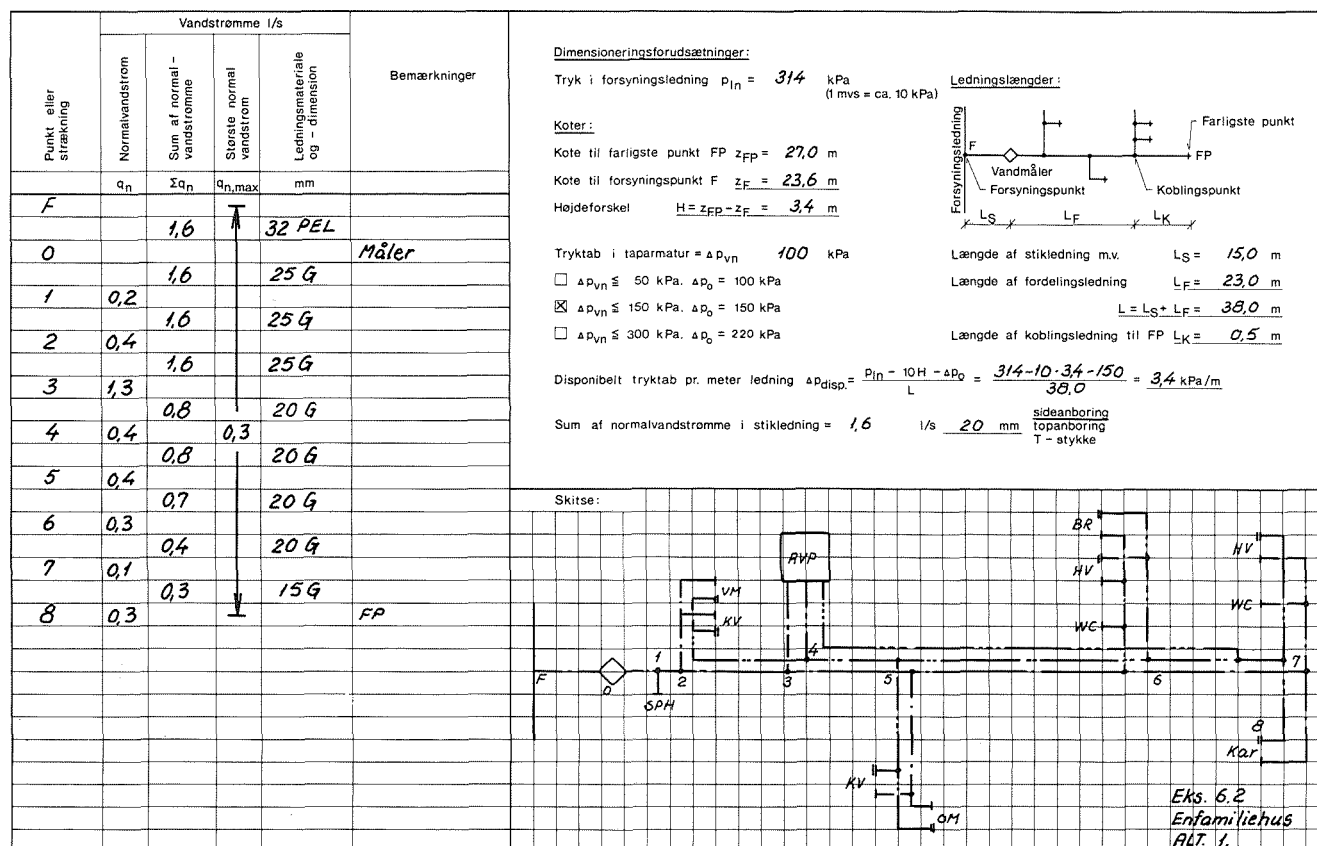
Forenklet dimensionering af installation til enfamiliehus (fig. 6.12 og 6.13), eksempel 6.2, traditionel installation med varmforzinkede stålrør. Den fuldstændige dimensionering af samme installation er gennemgået i eksempel 5.4.
